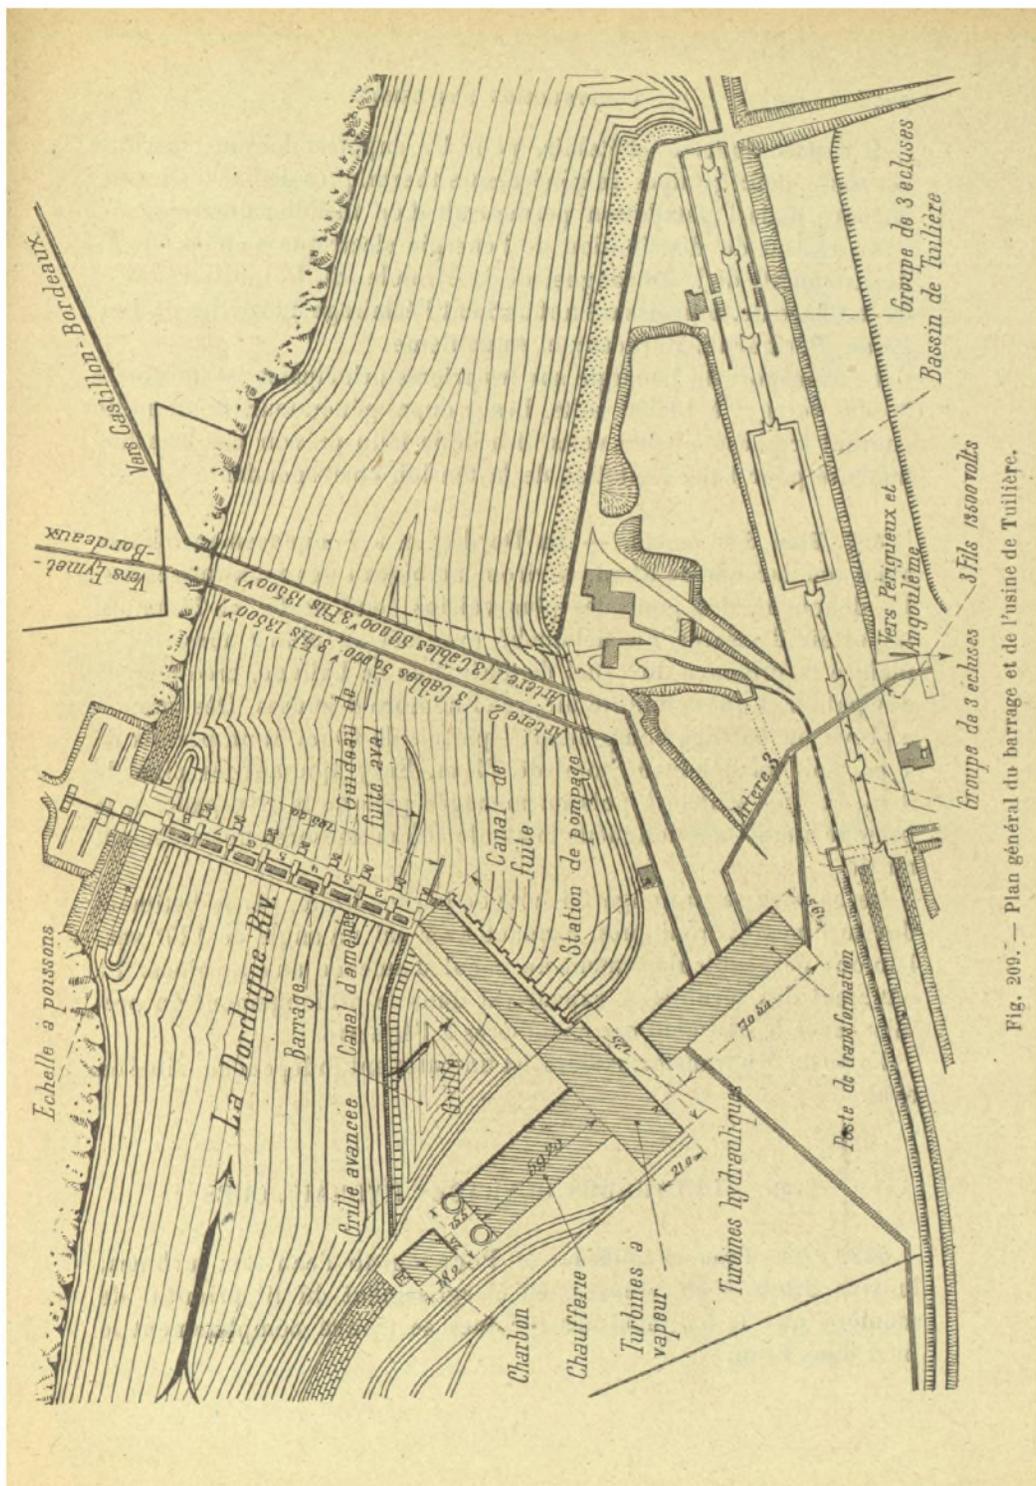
Plan général du barrage et de l'usine de Tuilière.
